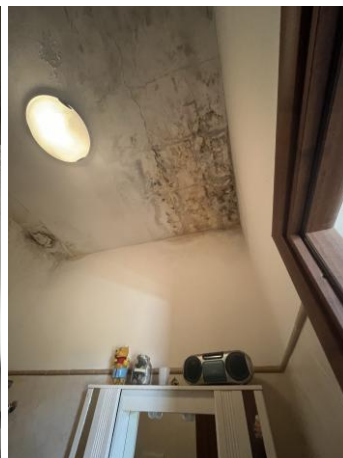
Ammaloramenti su intradosso di solaio piano secondo
